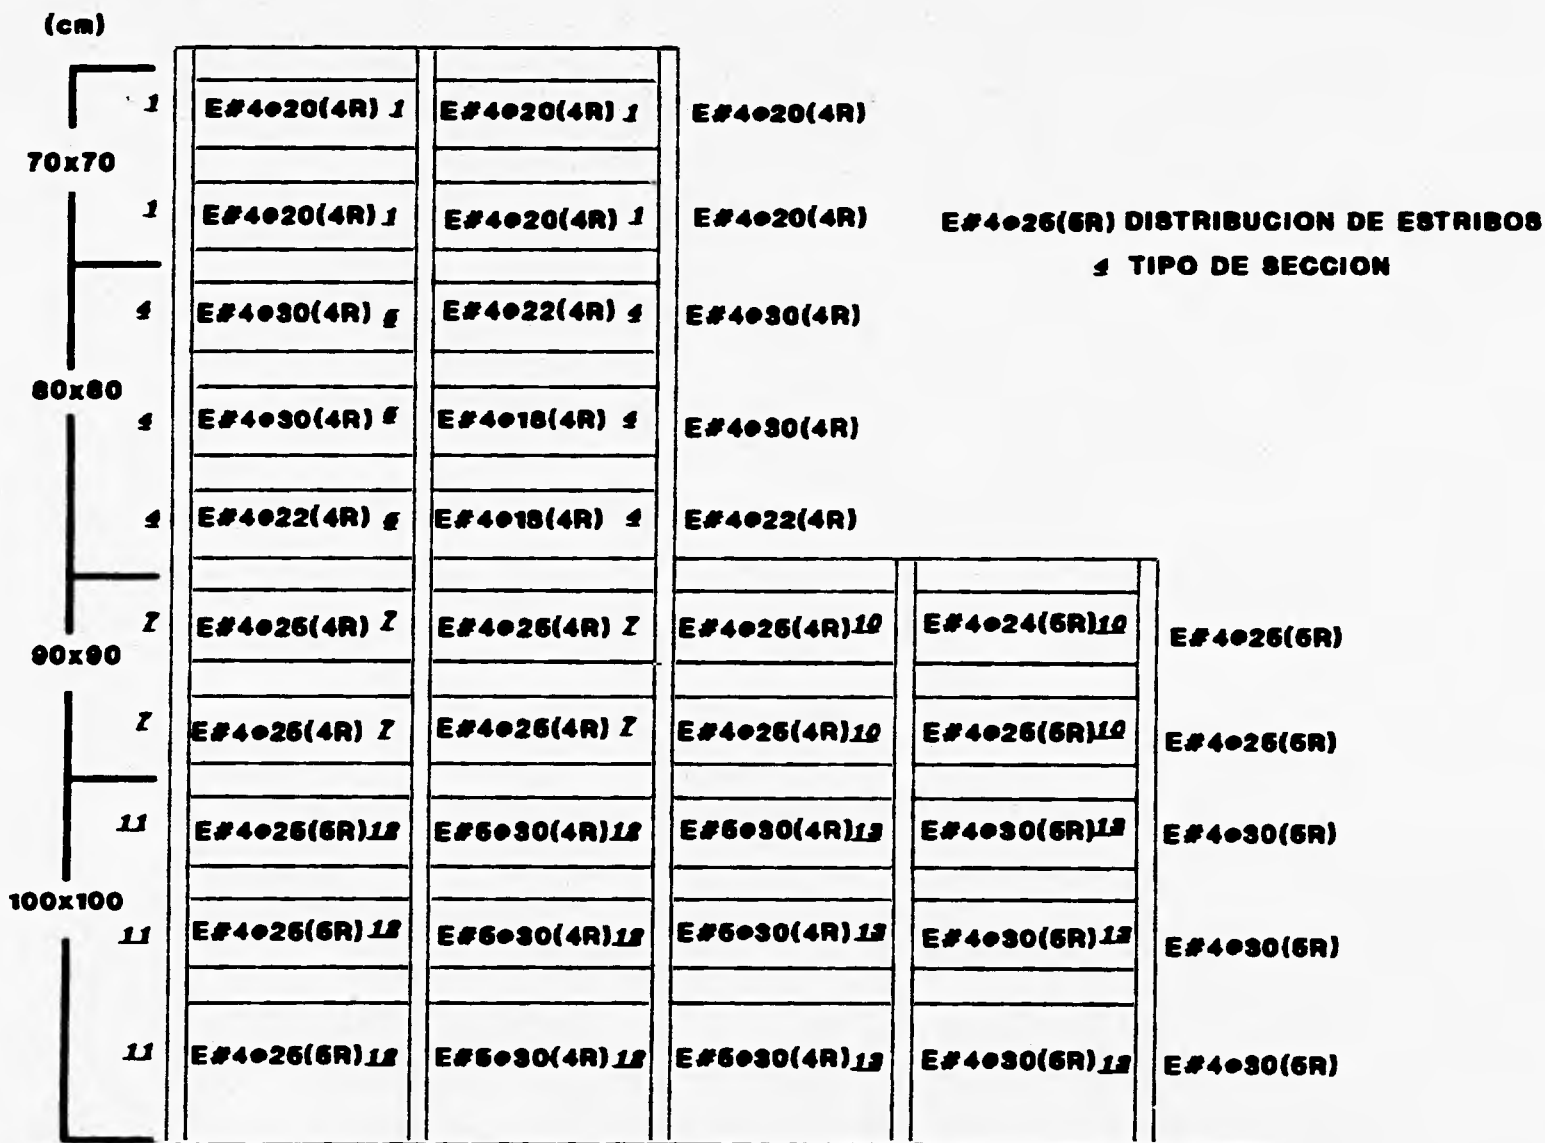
REFUERZO TRANSVERSAL EN ZONAS CENTRALES DE COLUMNAS, MODELO 1, Q=2
